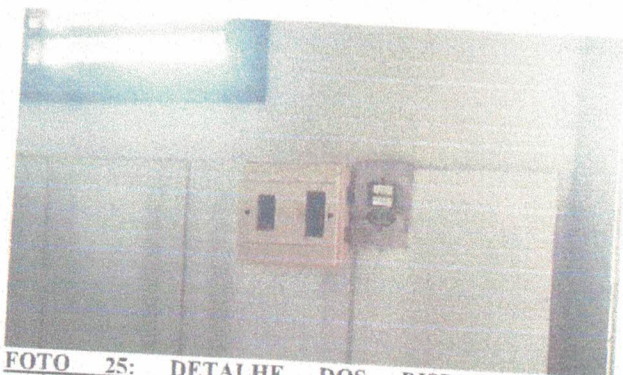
DETALHE DOS DISPOSITIVOS ELÉTRICOS DETERIORADOS.
